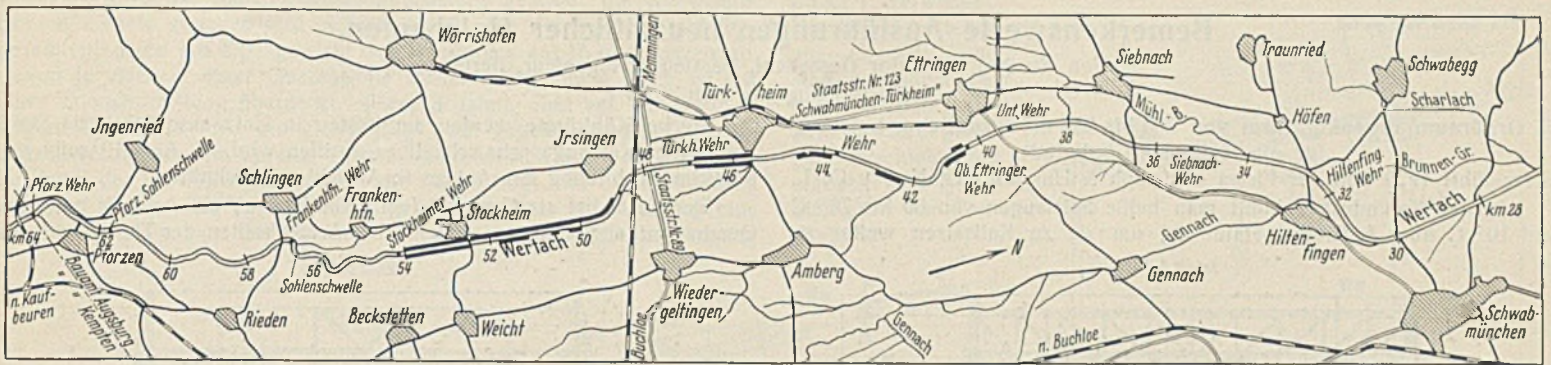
Ausbau der Wertach zwischen dem Stockheimer und dem oberen Ettringer Wehr. Übersichtslageplan.
